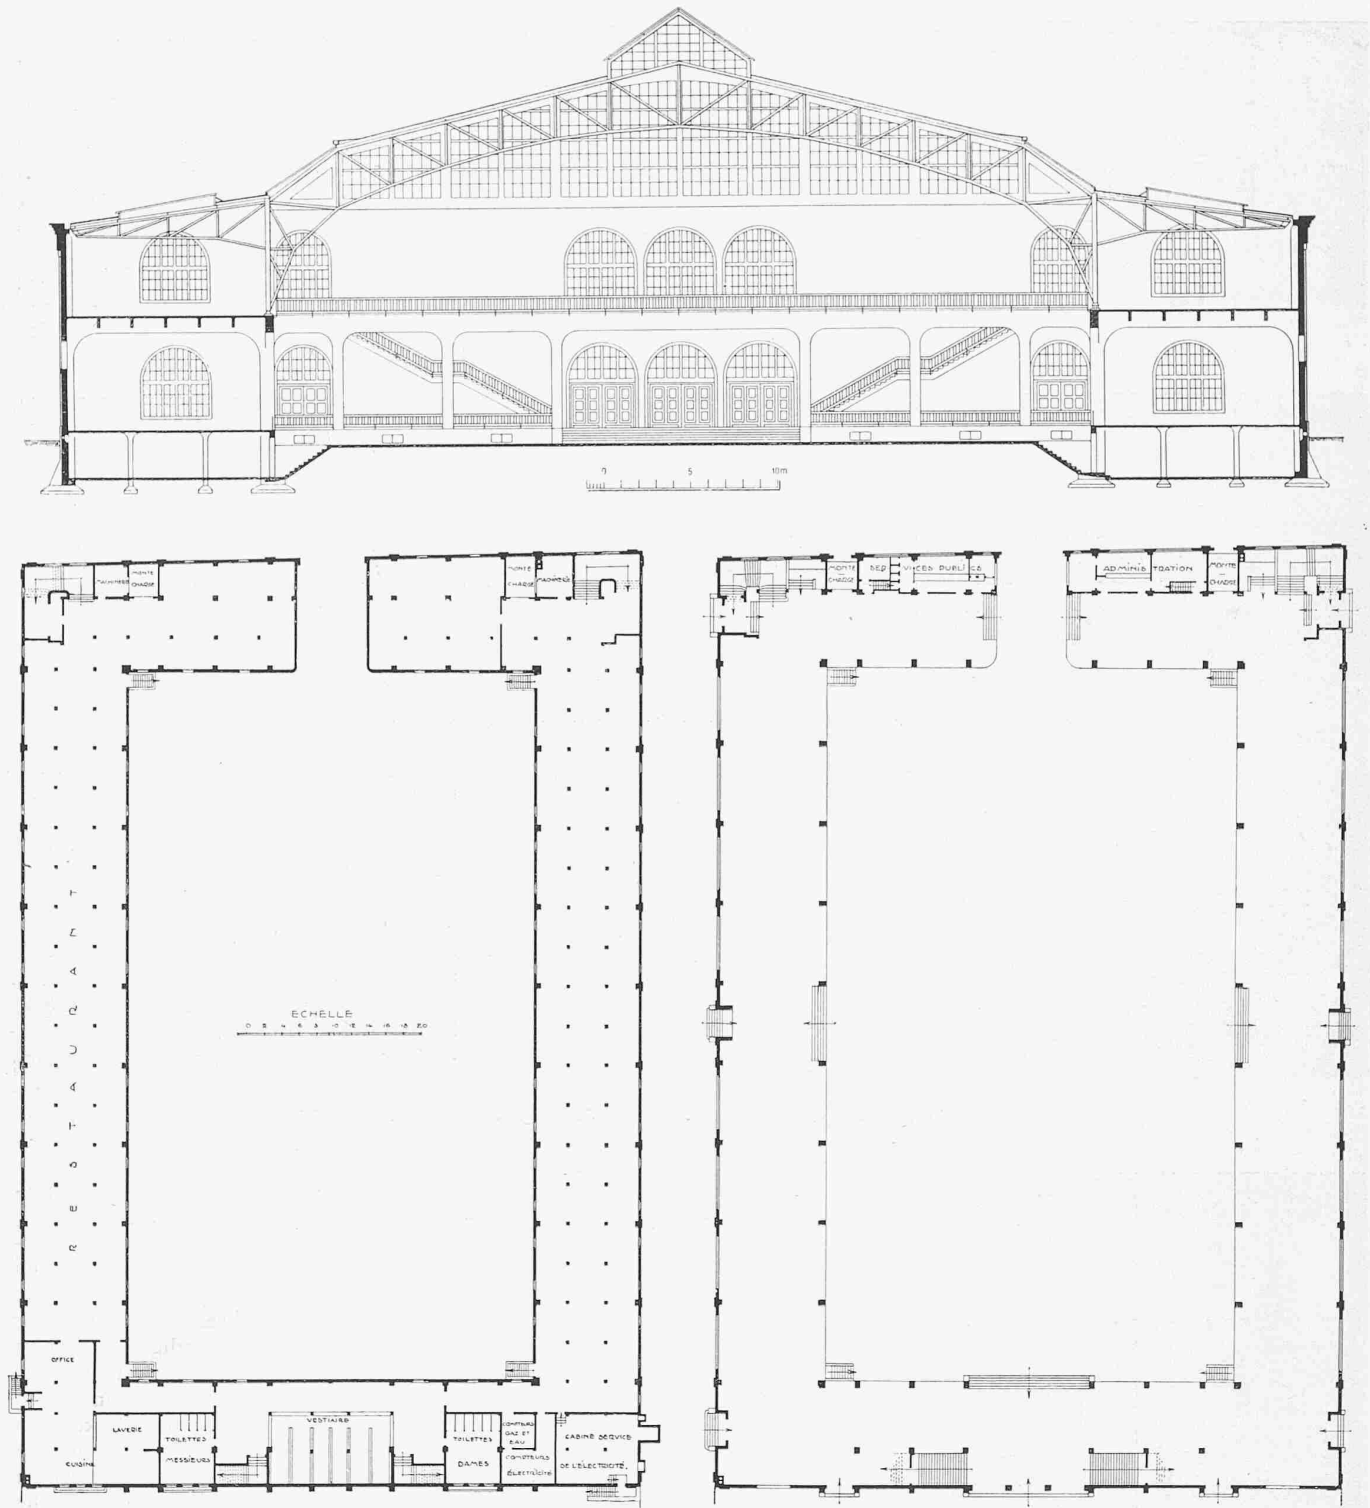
bis 4. Grundrisse von Keller- und Erdgeschoss, Masstab 1:800. — Querschnitt durch die Halle, Masstab 1:400.
